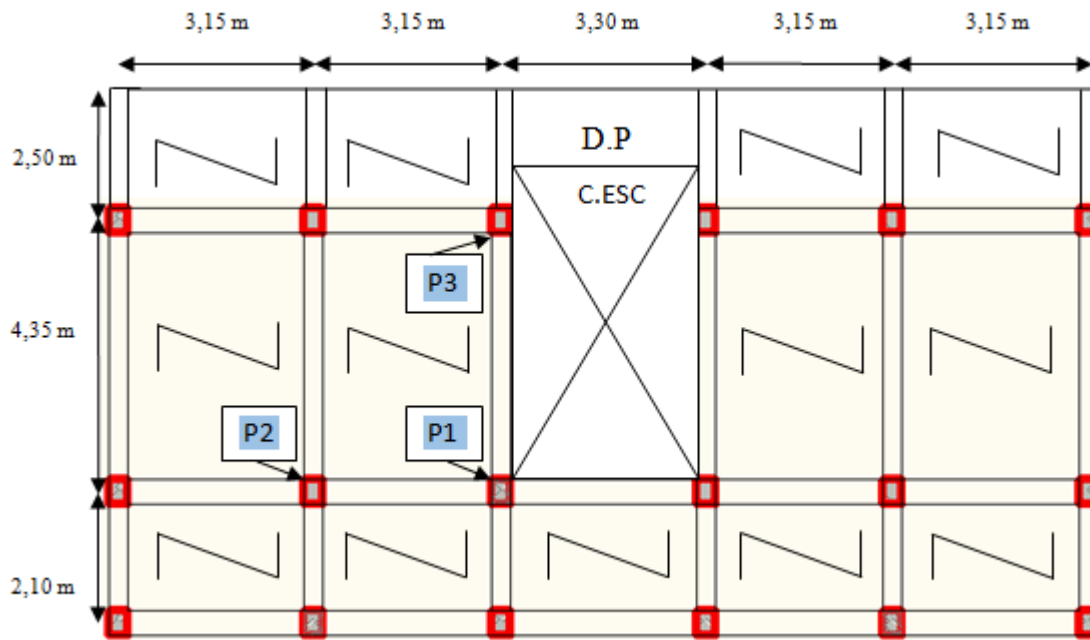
Plan de disposition des poutrelles (entre sol 1)
